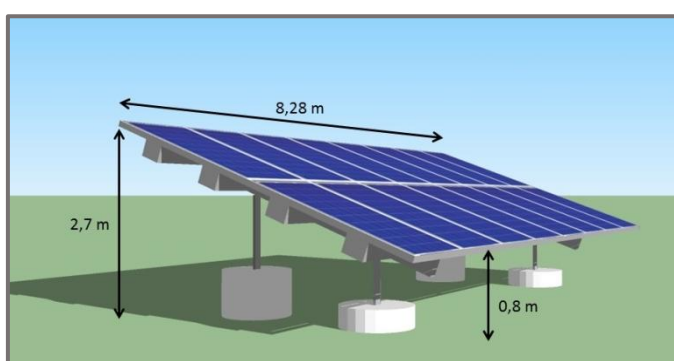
Illustrations 3D d'une structure support avec pieux hybrides (Source : IEL)
